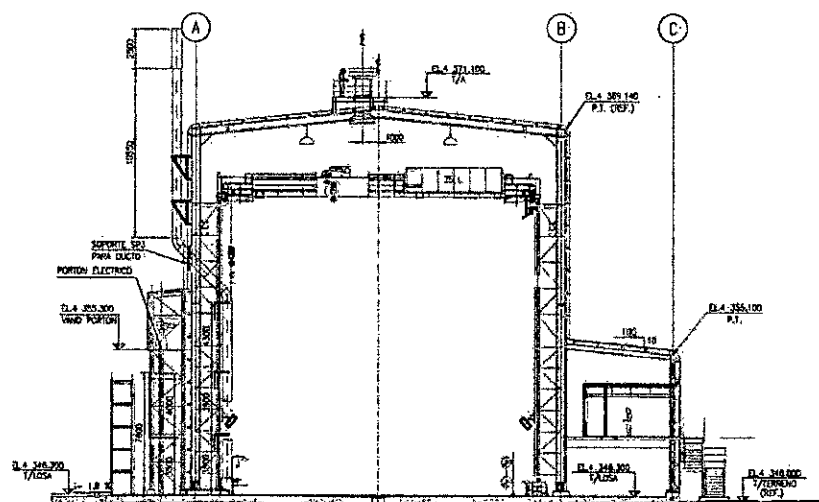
vista de elevación de las nuevas bahías de mantenimiento
